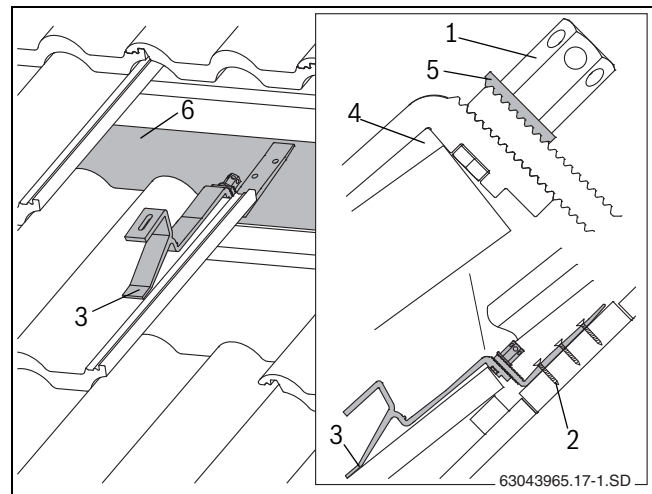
Gancho de tejado montado (para facilitar la vista se han eliminado de la figura algunas tejas)
